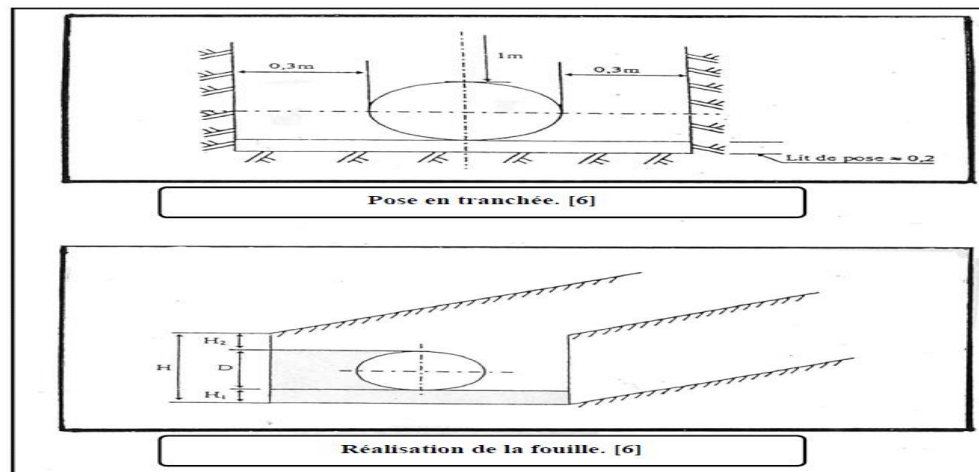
Schéma d'une tranchée avec une conduite circulaire
